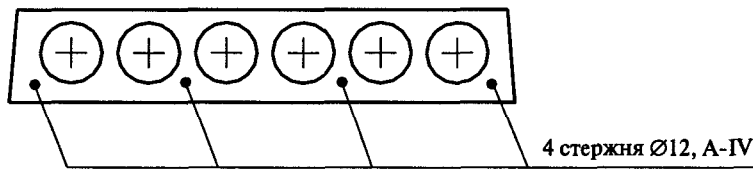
Армирование плиты, напрягаемой арматурой, — к примеру 7.12
